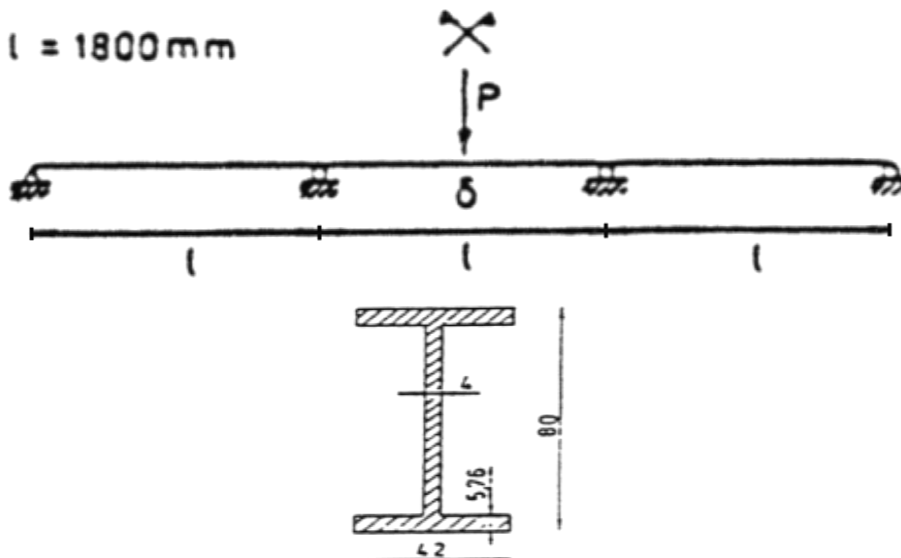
Poutre de STUSSI et de KOLLBRUNNER
